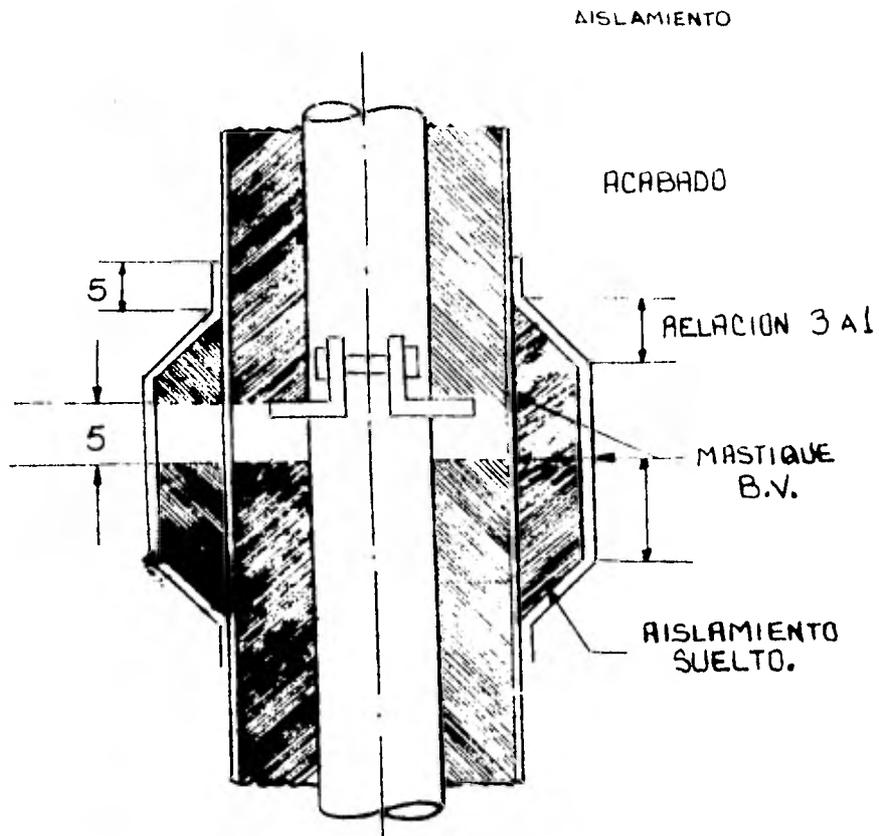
Soportes de Aislamiento en Tubería Vertical.
